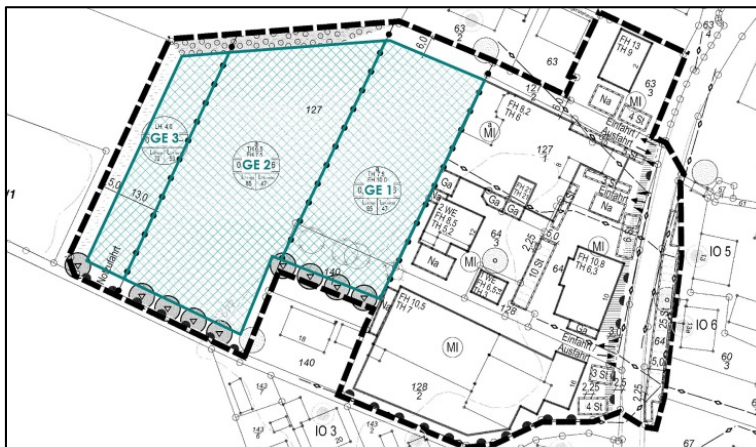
Bebauungsplan mit Eintragung der Emissionsbezugsflächen  $S_{EK}$
